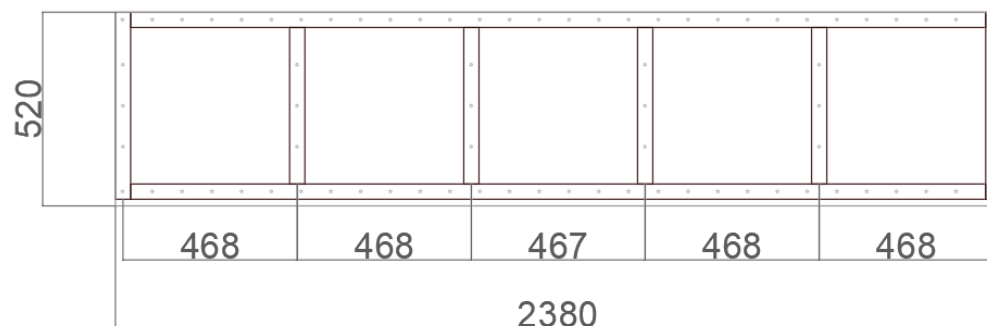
Vista en planta módulo para ensayo, ancho adaptado
